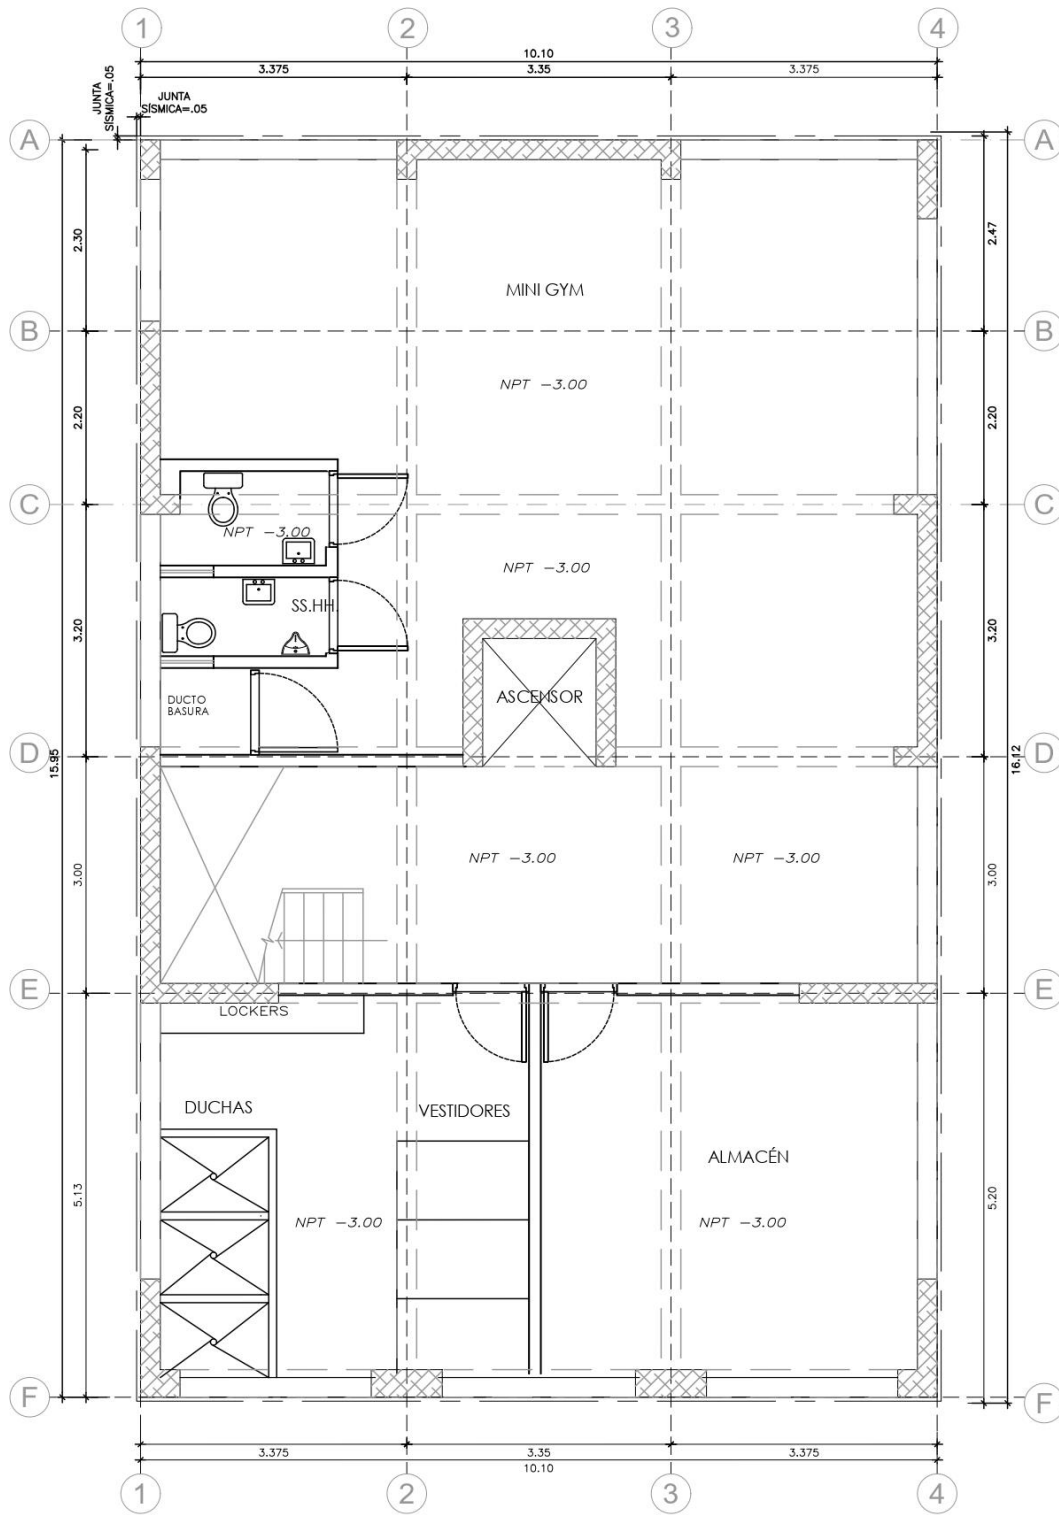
Planta arquitectónica de sótano. Fuente: Propia.
